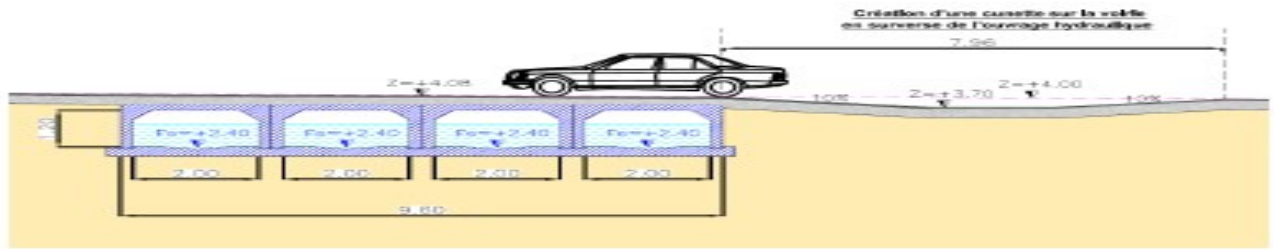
Coupe de l'ouvrage hydraulique n°2
